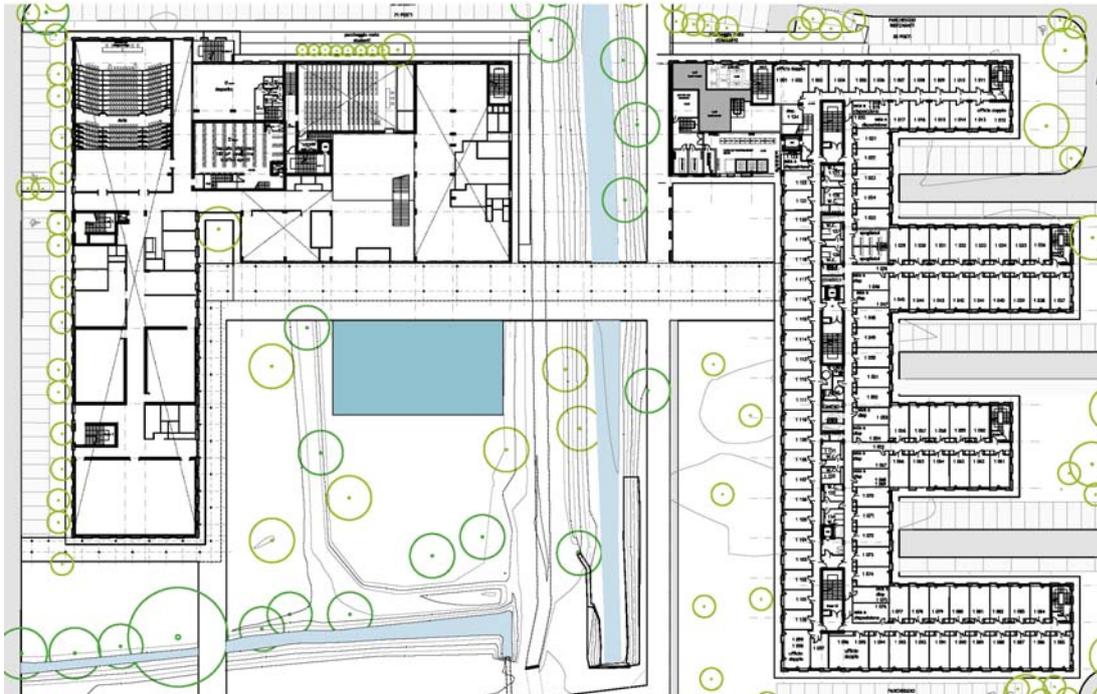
Pianta piano primo Lotto 1-2 e identificazione funzionale
